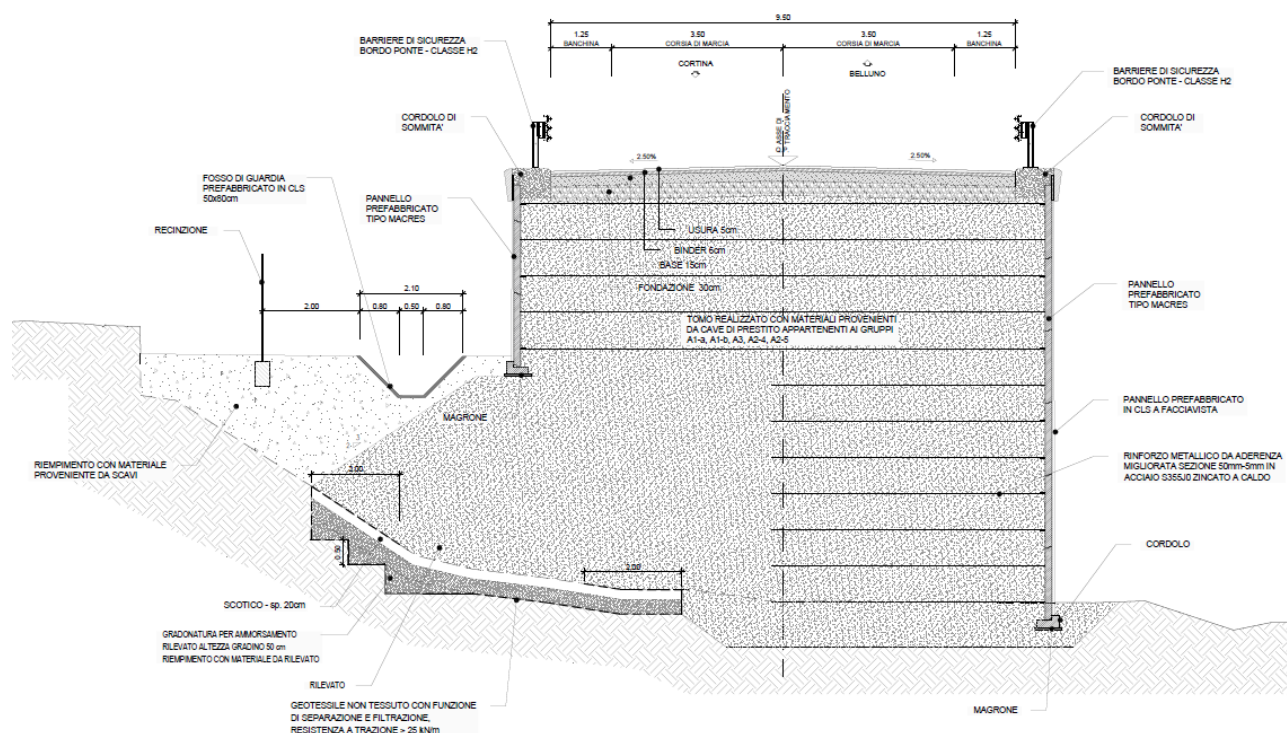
Asse Principale - Sezione tipo con terre armate
